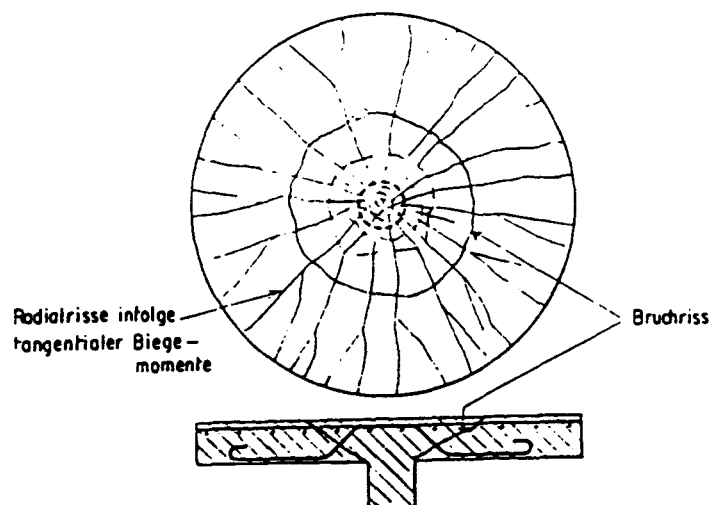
Schematische Darstellung des Rissbildes im Stützenbereich einer Flachdecke
